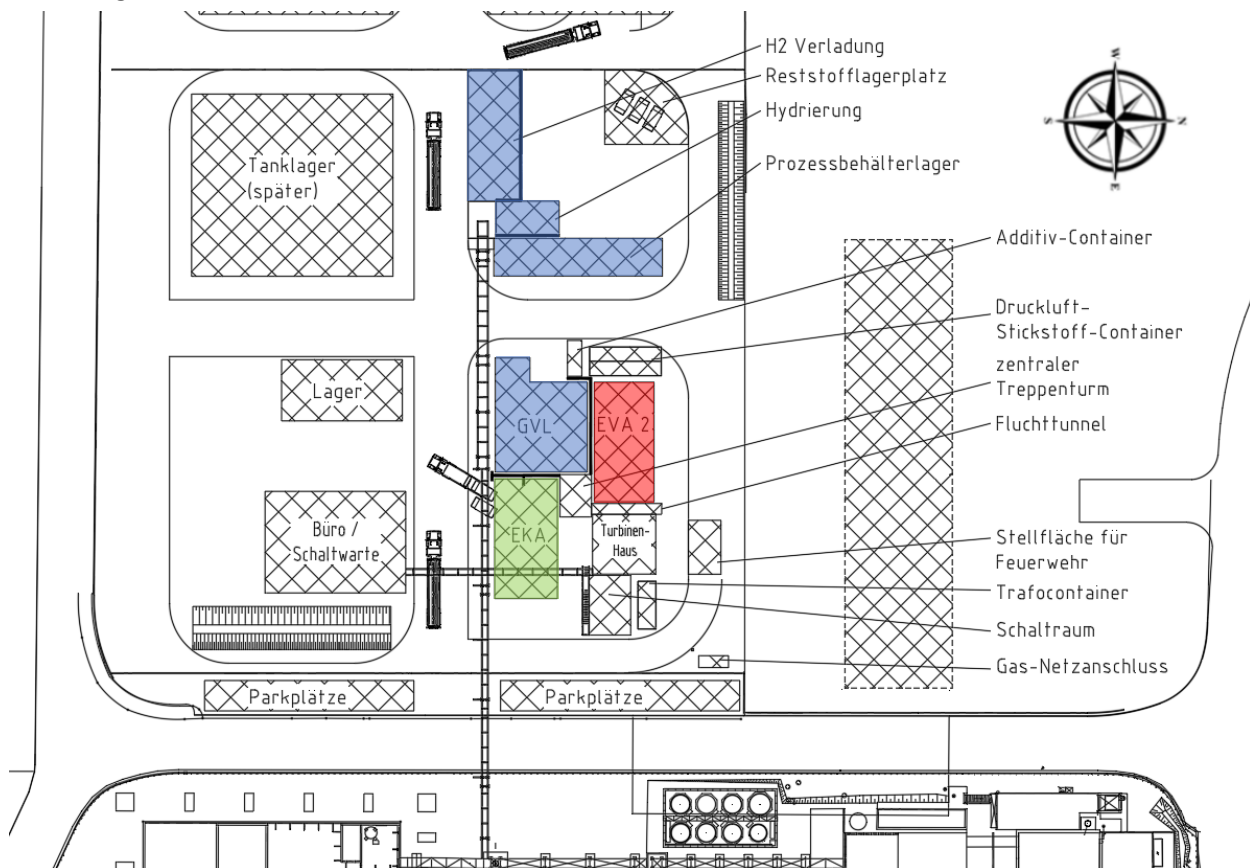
Grundriss der Neuanlagen. GVL-Anlage in Blau; EVA2-Anlage in Rot; EKA-Anlage in Grün. Östlich davon befindet sich die GLACON Bestands-Anlage
